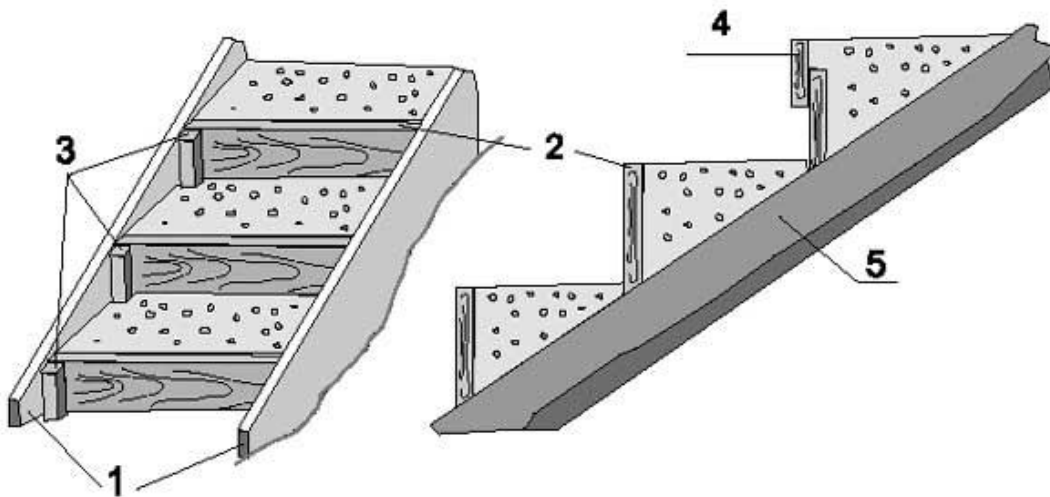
Влаштування сходів з бетонуваними ступенями: 1 – боковини опалубки; 4 – підпiр для ступеня з навісом; 2 – підпiрні дошки; 5 – підстава подушки 3 – упори (бруски).
